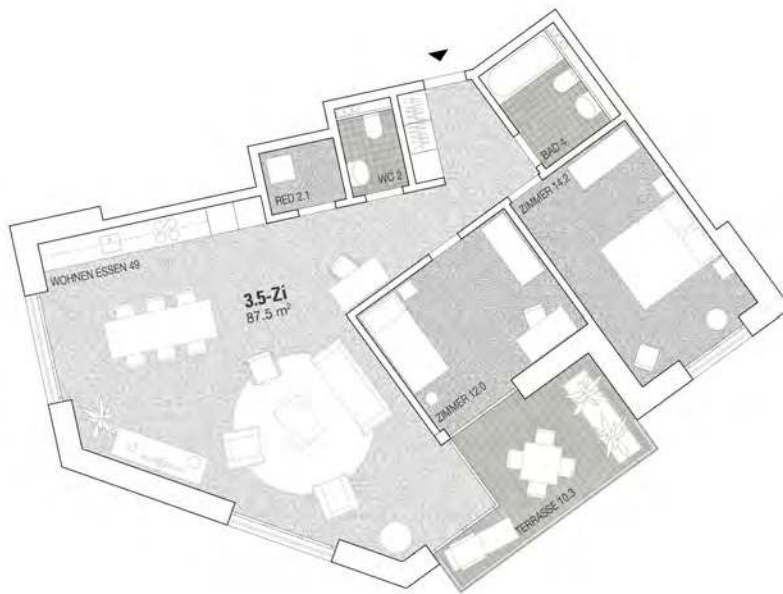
Leon: Wohnungsgrundriss 3.5-Zimmer-Whg.
